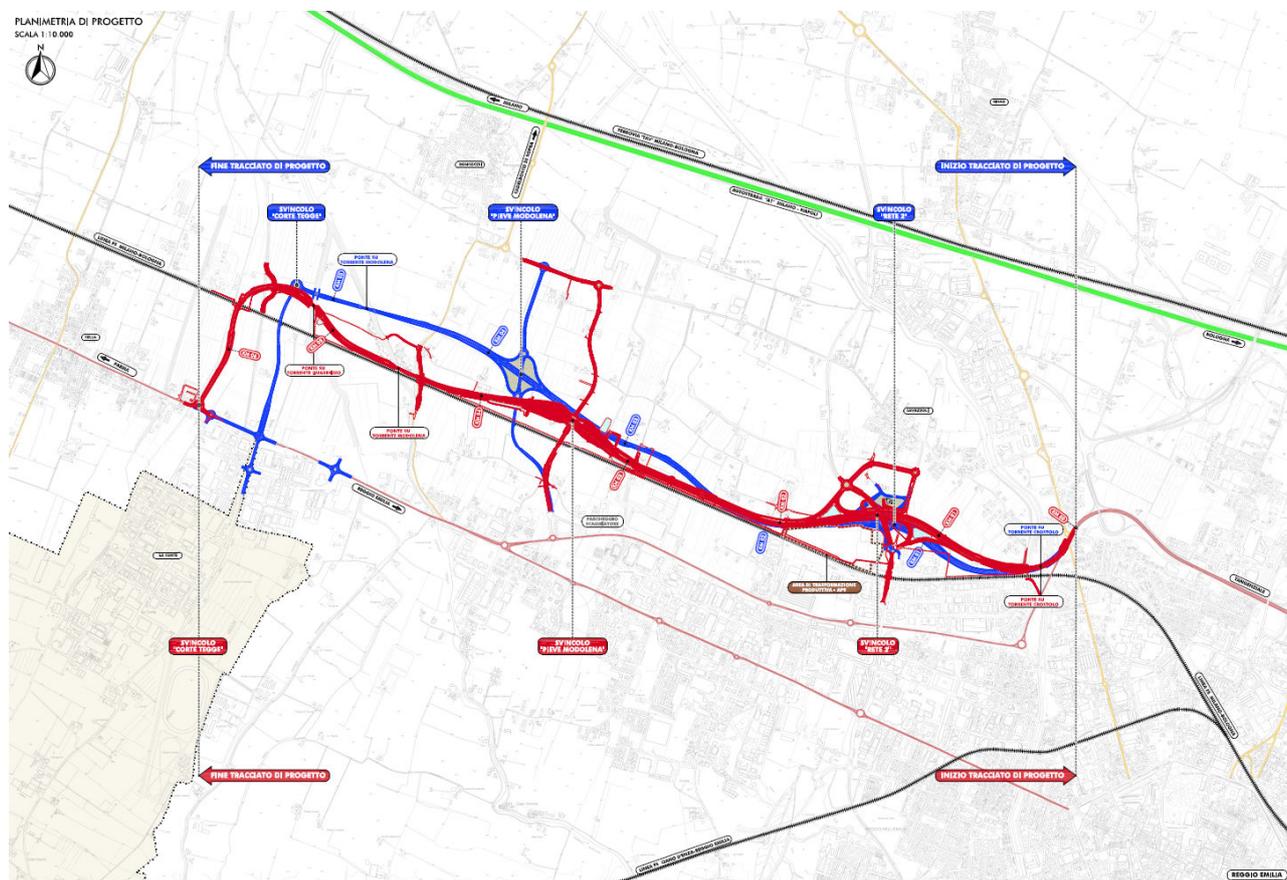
Planimetria di raffronto tra la Soluzione Alternativa A (tracciato blu) e la Soluzione Alternativa B (rosso)
